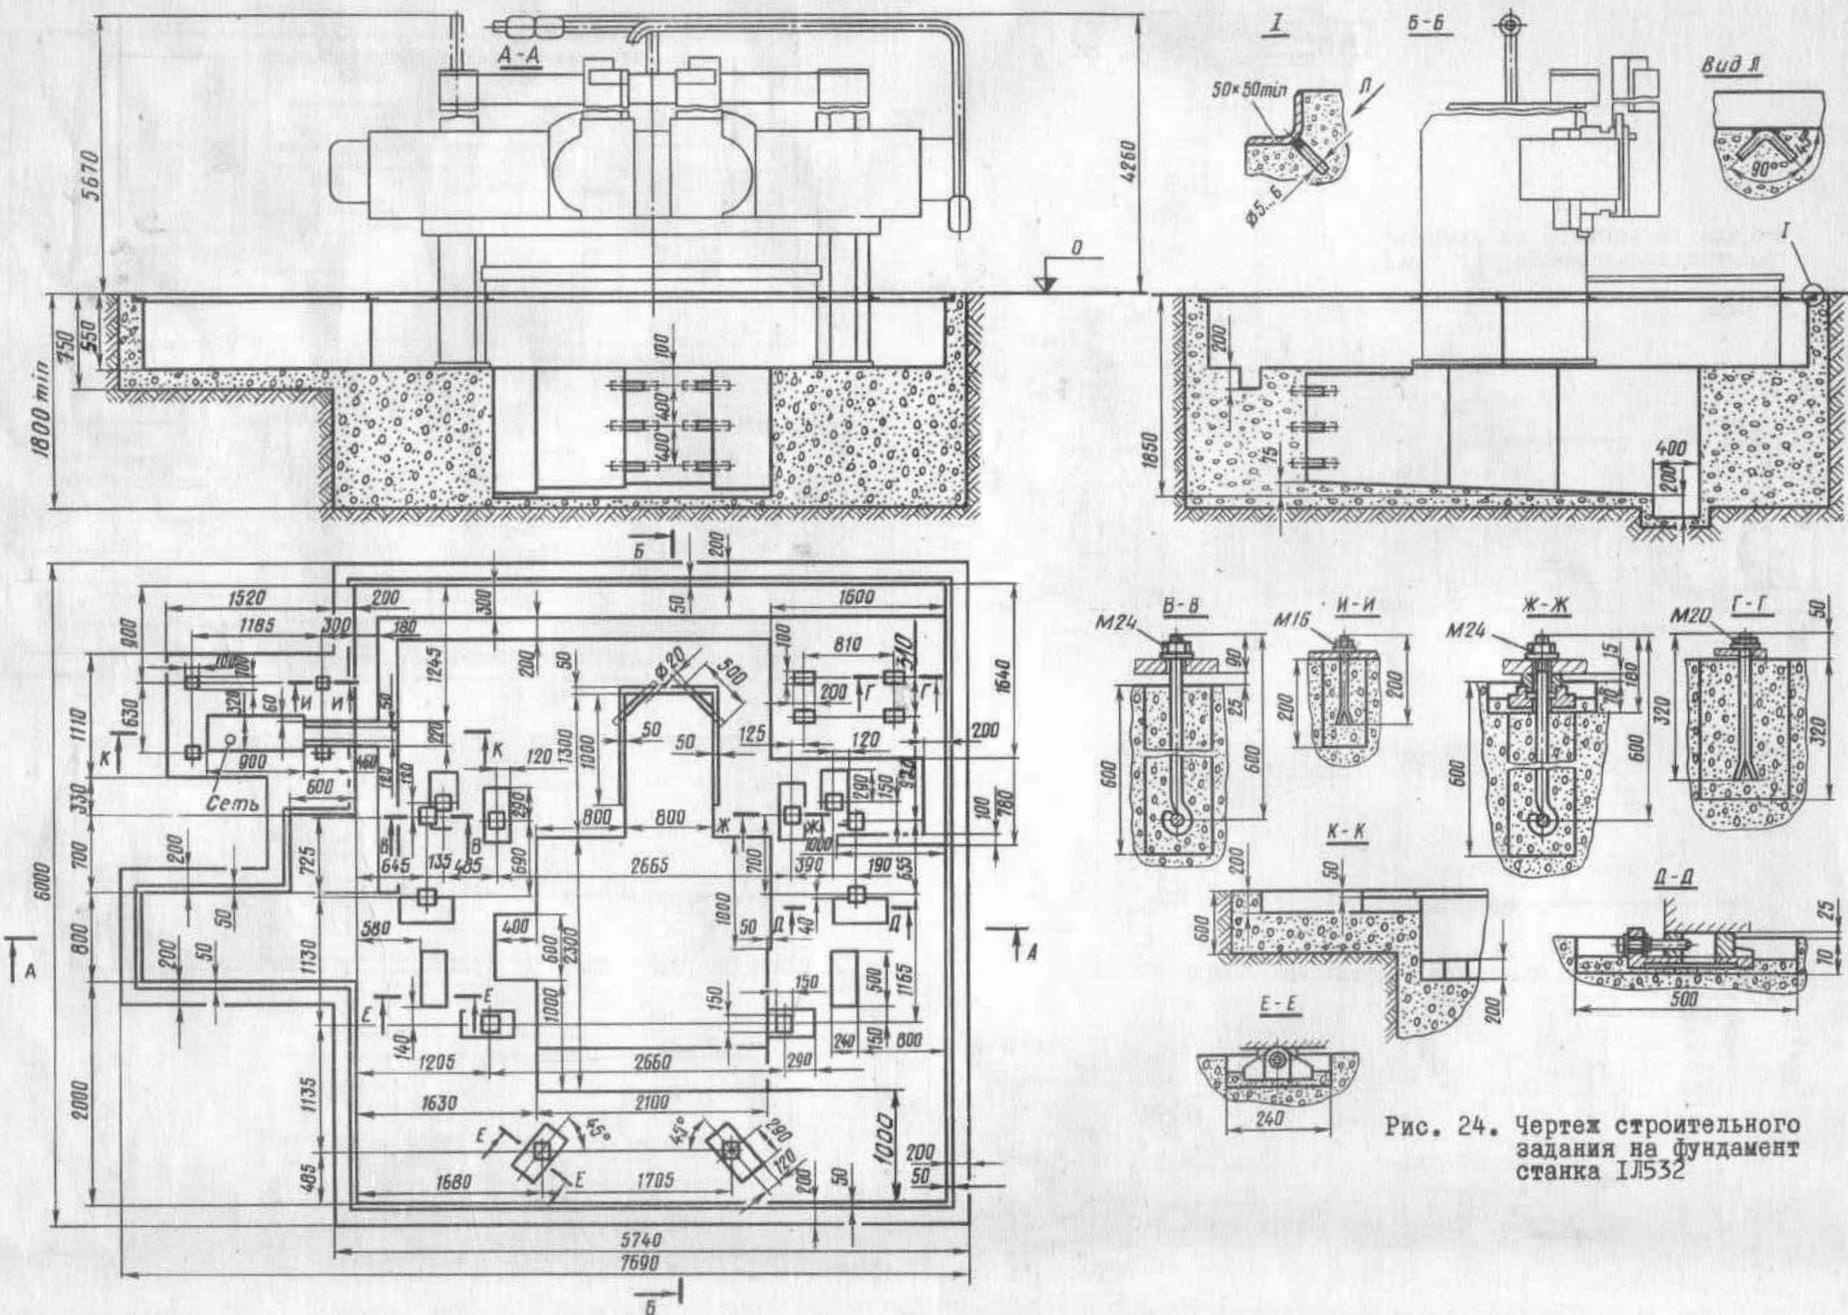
Чертеж строительного задания на фундамент станка ИЛ532
